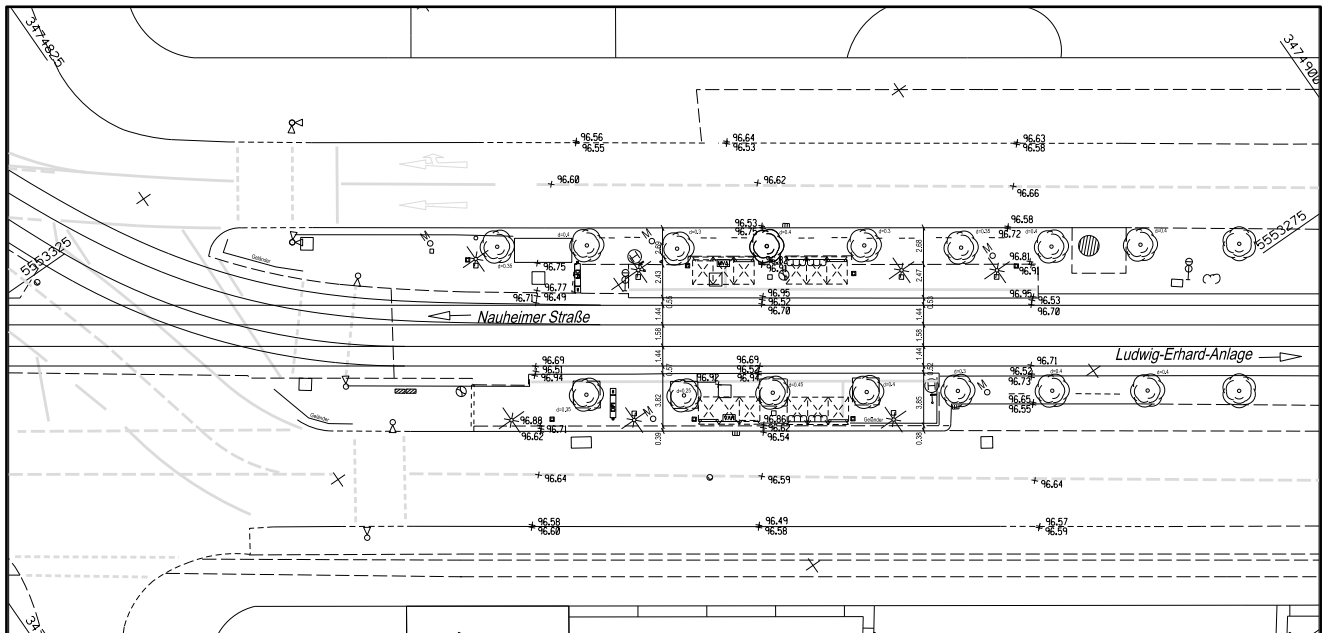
Haltestelle Varrentrappstraße, Bestandsplan (Auszug) [R3]
